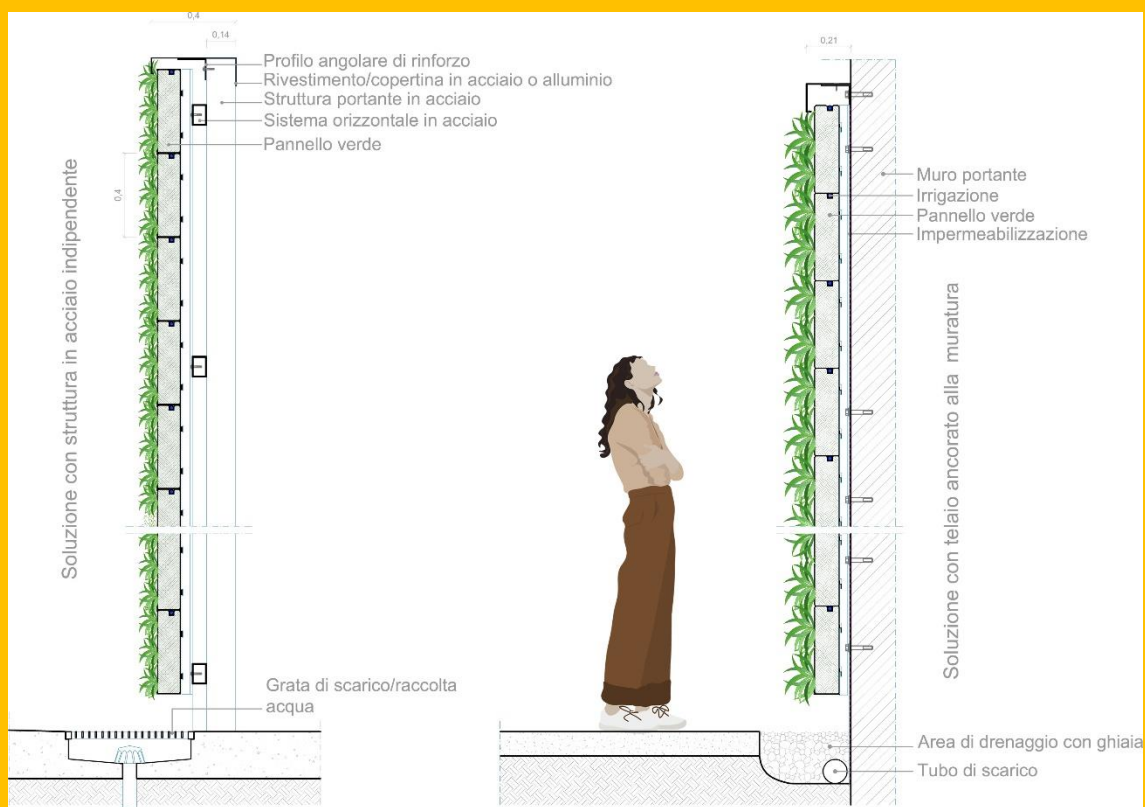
SEZIONE TIPO DI UNA PARETE VERDE CON SUBSTRATO LEGGERO E STRUTTURA IN ACCIAIO INDIPENDENTE O ANCORATO ALLA MURATURA. DISEGNI DA ARCHWEB.IT, GRAFICA DELL'AUTRICE.
